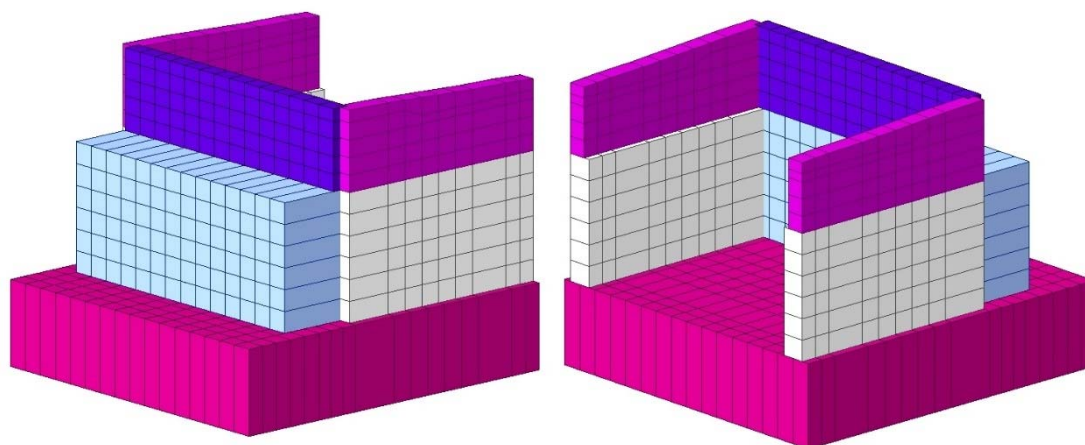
Modello 3D Spalla S3 – Vista anteriore e posteriore
